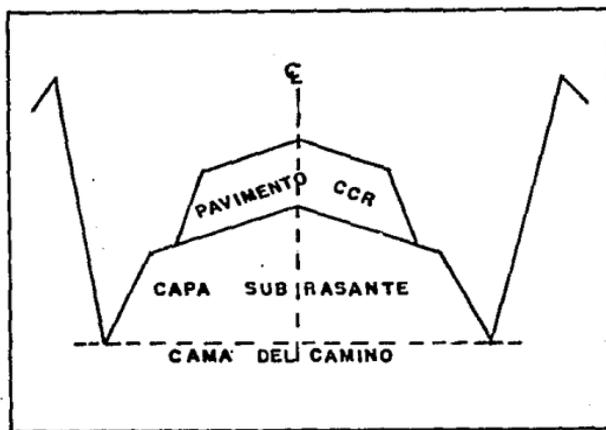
CORTE TRANSVERSAL DE UN PAVIMENTO DE C.C.P.
